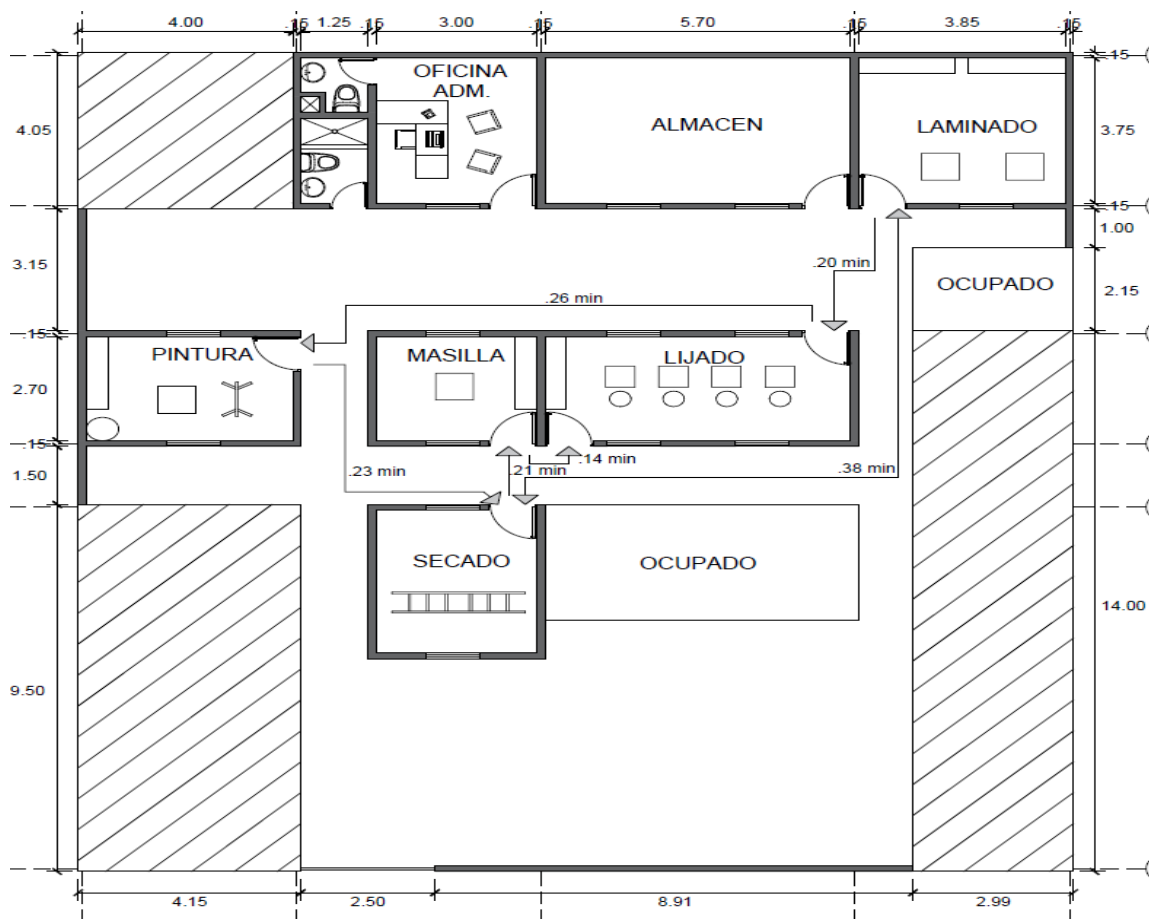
Distribución de planta antes de la implementación del plan de mejora
